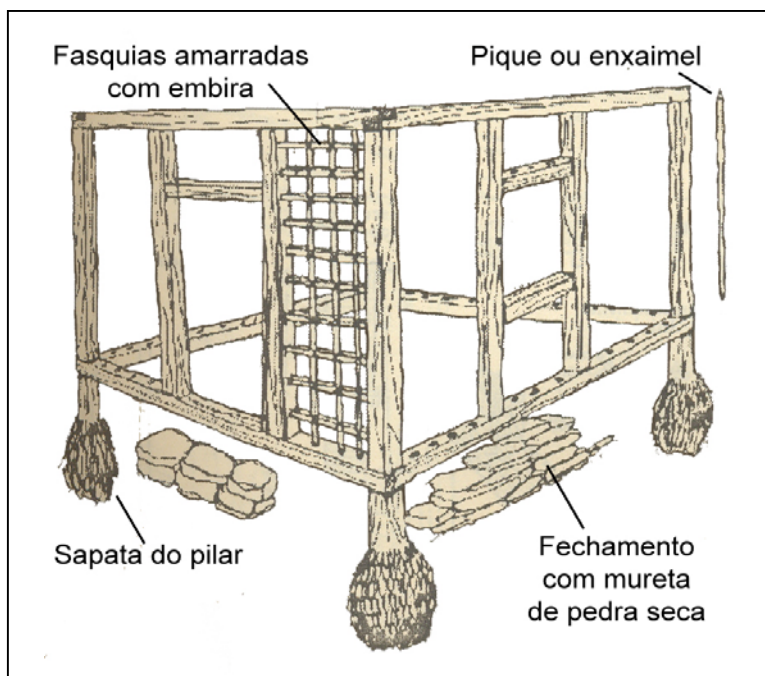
Esquema estrutural de uma casa de taipa de mão.
